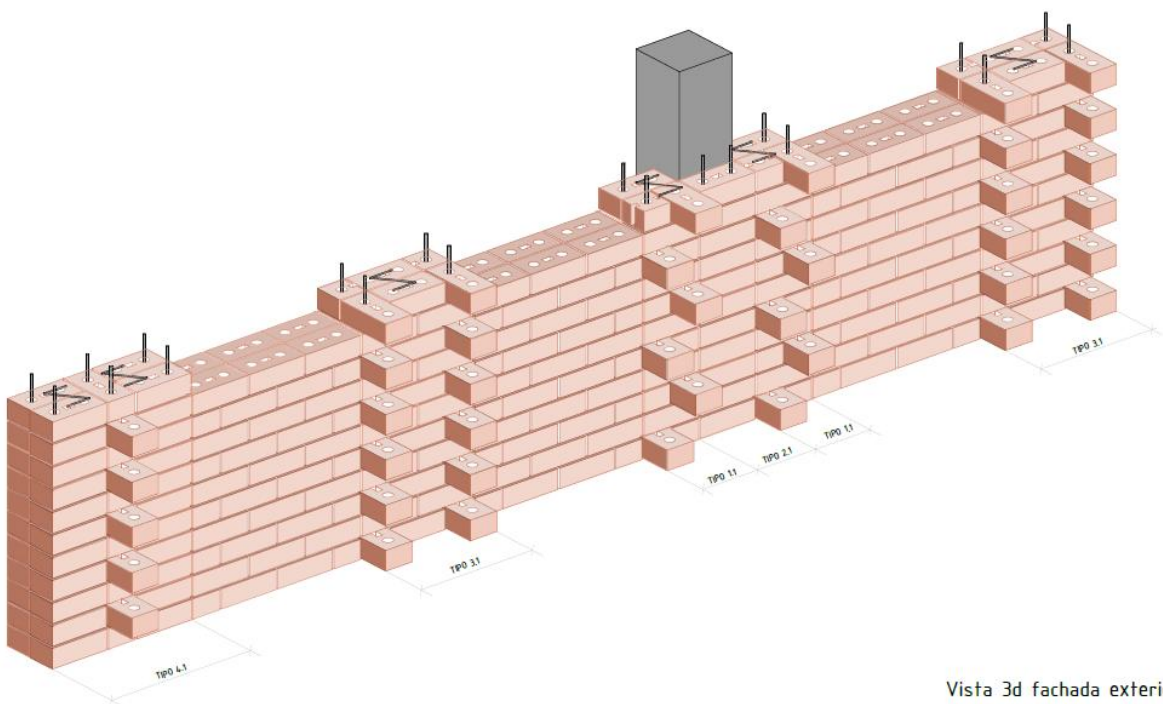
Vista axonométrica construcción módulos fachada exterior
